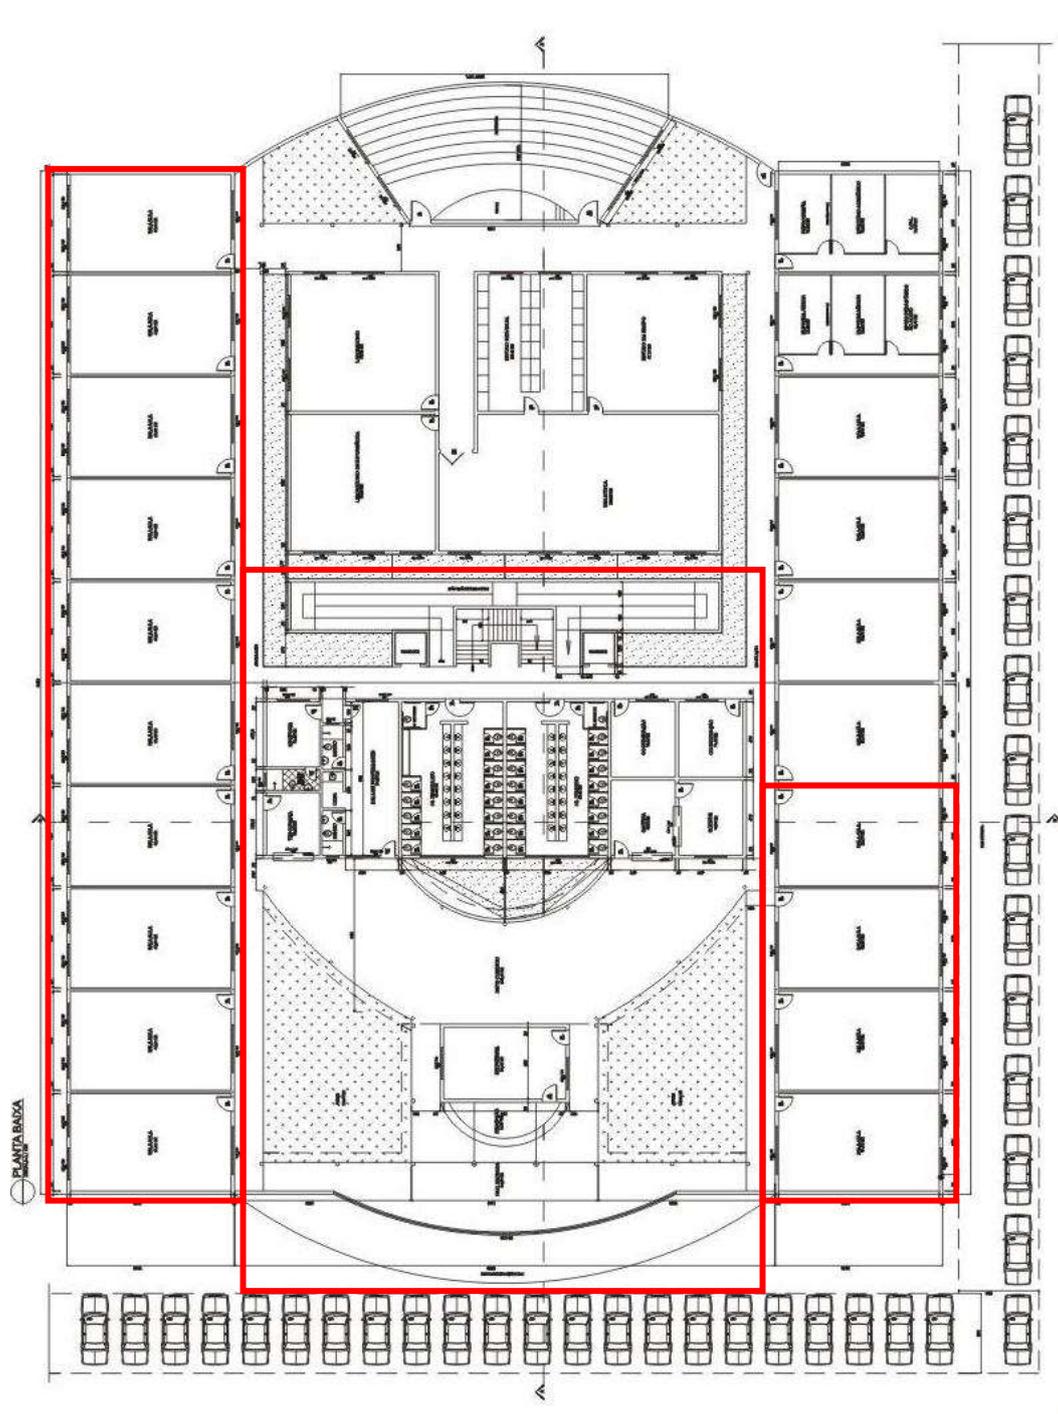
Projeto Arquitetônico – 1º Piso – Construção da sede – área construída
